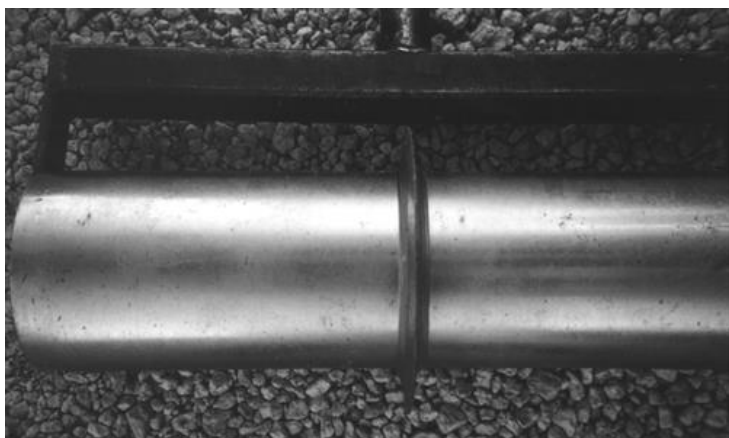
Fig. 2.58 Vista detallada de la herramienta de juntas para concreto permeable.
